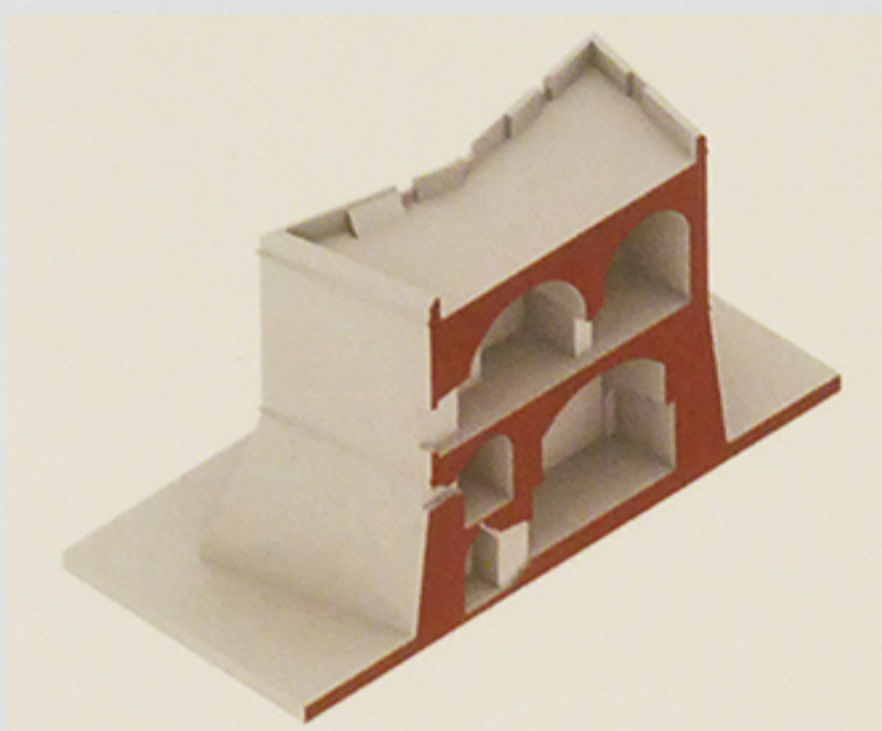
Torre di S. Pietro in Bevagna. Ipotesi sezione assonometrica del complesso nel XIX secolo.
